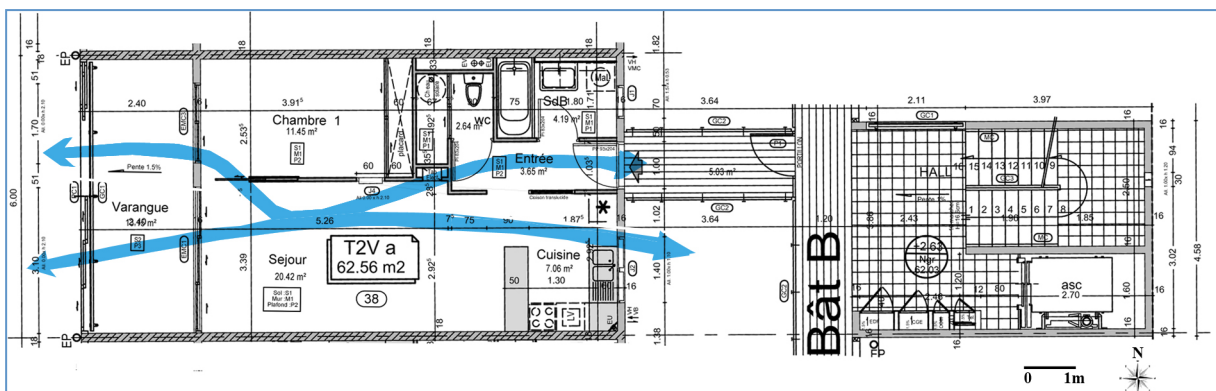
Îlet du Centre, Plan T2Va, Bâtiment B, Ventilation traversante [Agence 2APMR]
